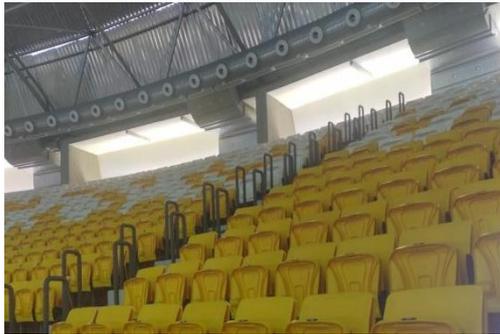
Detalhe dos insufladores do sistema de climatização e cadeiras do pavimento superior
